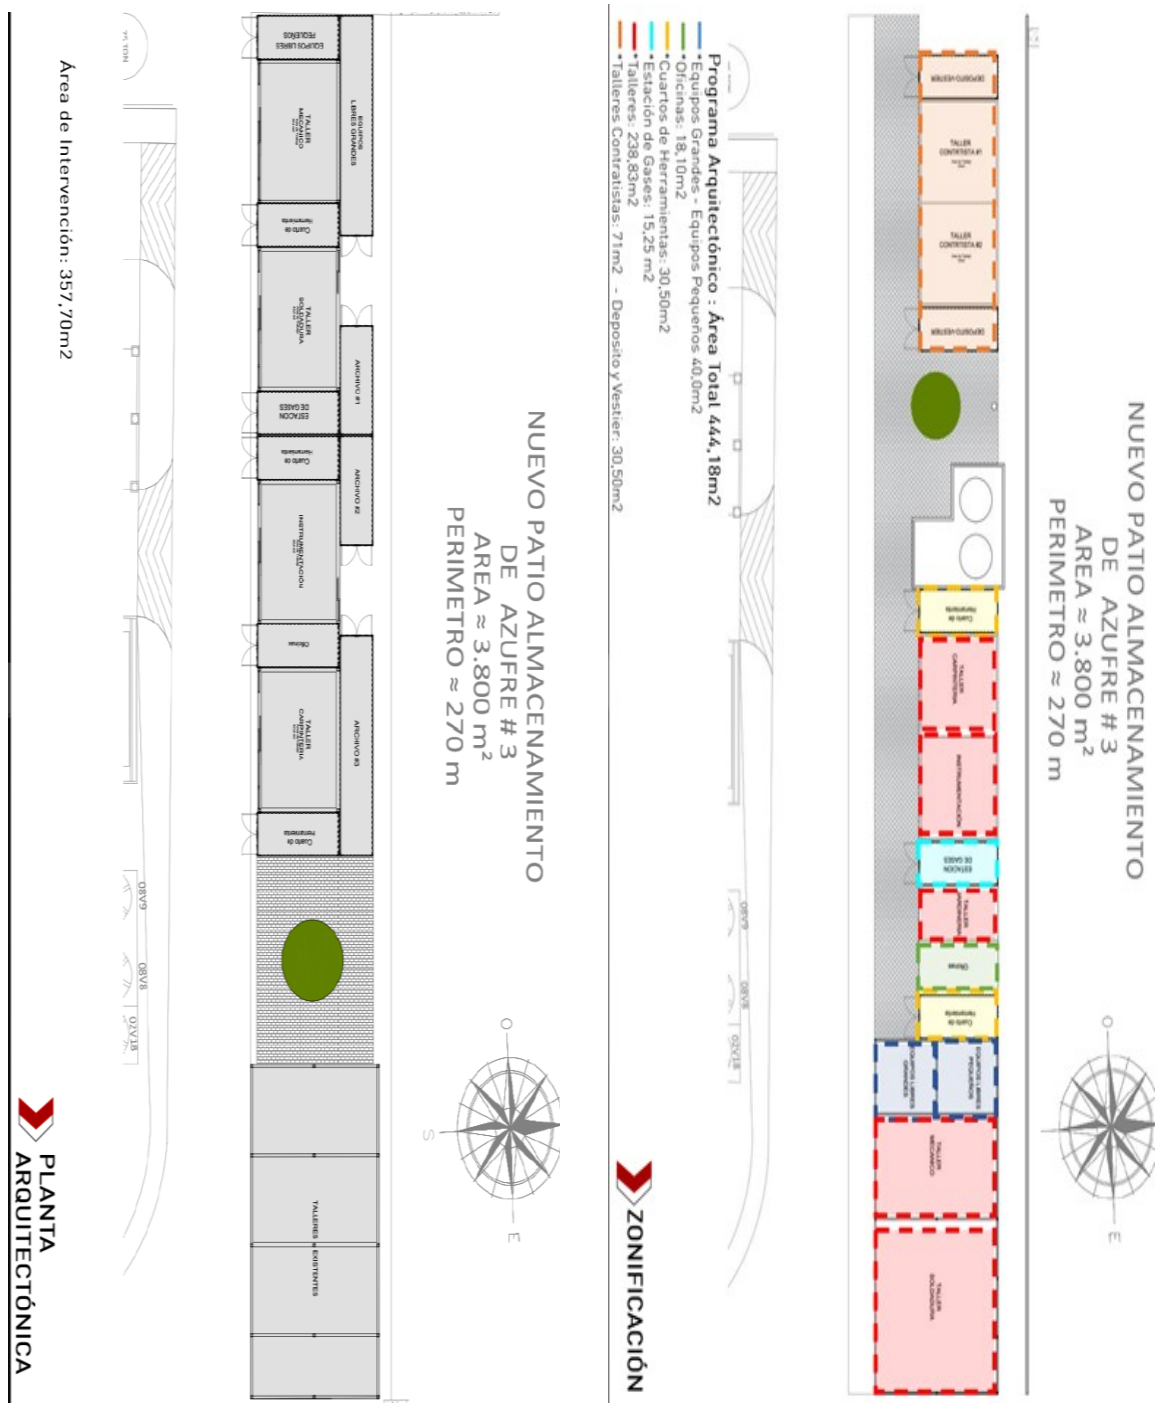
Planimetría Talleres Graficacion Empresa 180° arquitectos
